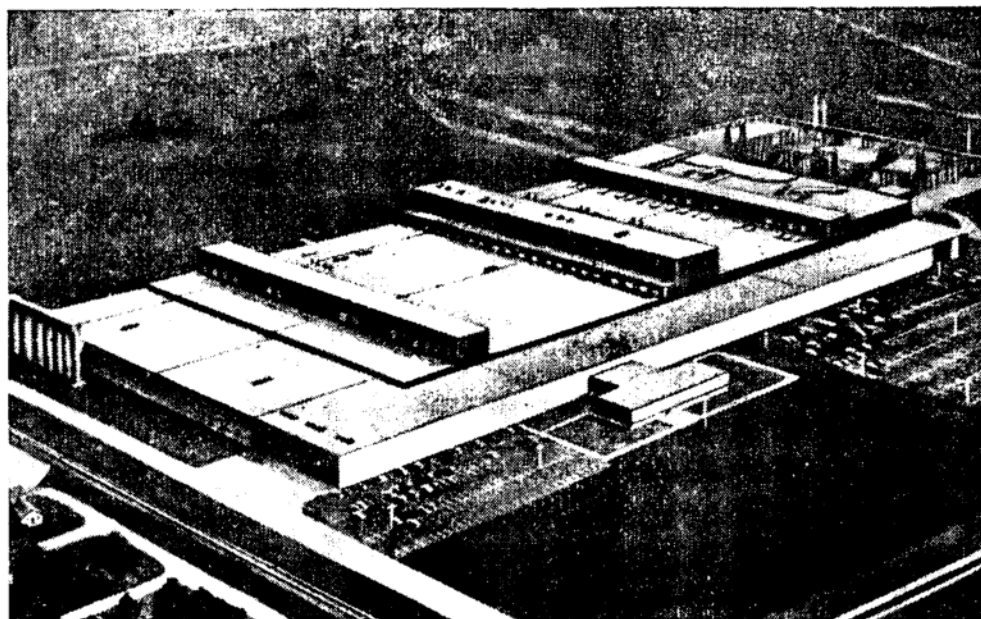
Пример решения современного зарубежного литейного цеха; многопролетное одноэтажное здание сплошной застройки. На кровле размещены приточные вентиляционные центры
